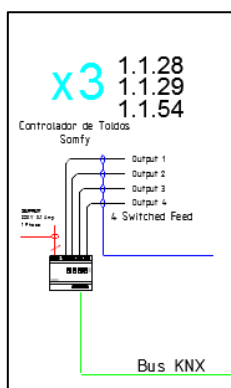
Controlador de Toldos en esquema de Planta Baja
